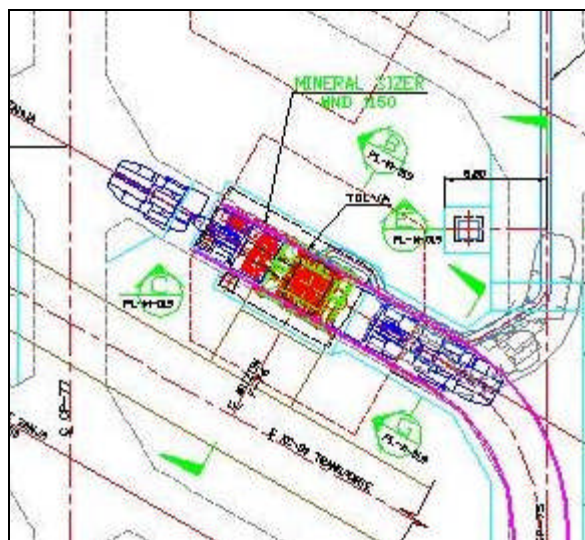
Opción 4.2, planta sizer en pozo en una zanja.
